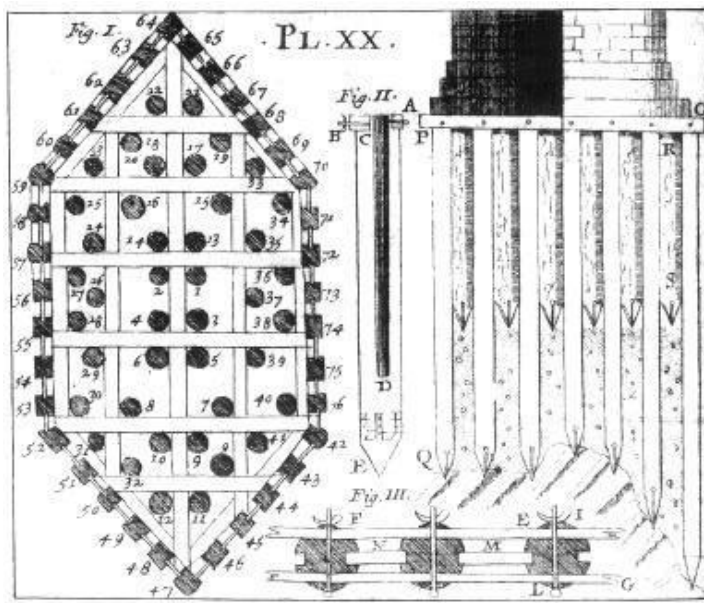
Fondazione su pali in legno risalente all'inizio del XVIII secolo: pianta di disposizione dei pali con indicazione dell'ordine di battitura degli stessi (fig. I), sezione della fondazione (fig. II), dettaglio del grigliato (fig. III). [18]
